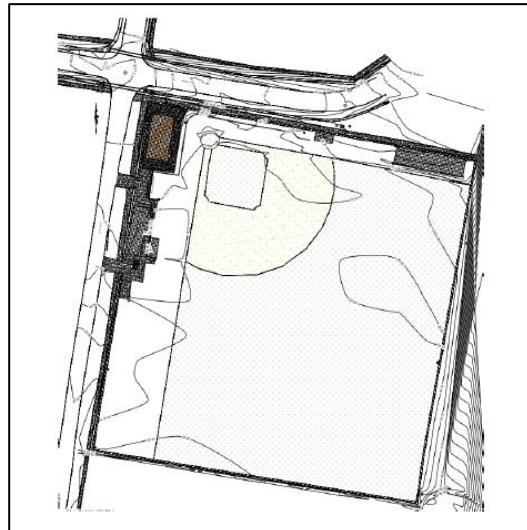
Plano Levantamiento topográfico del polígono del proyecto
